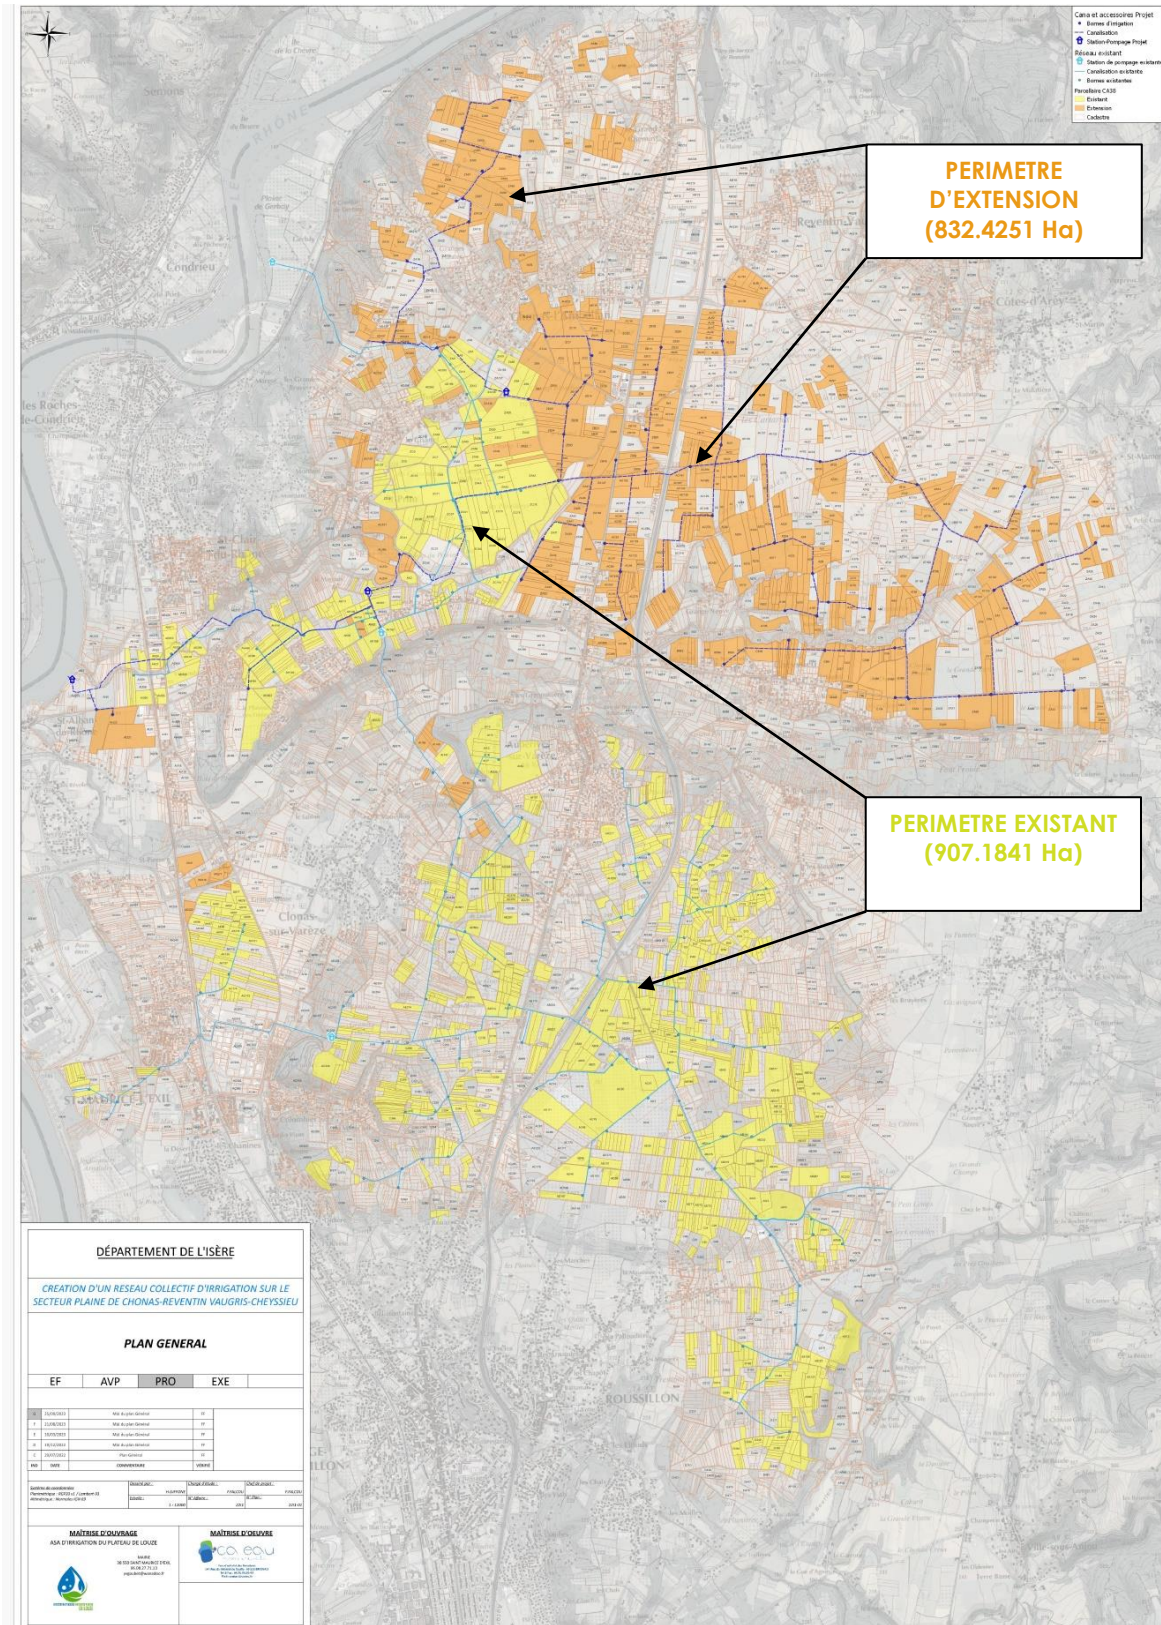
PLAN GENERAL DES DEUX PERIMETRES
